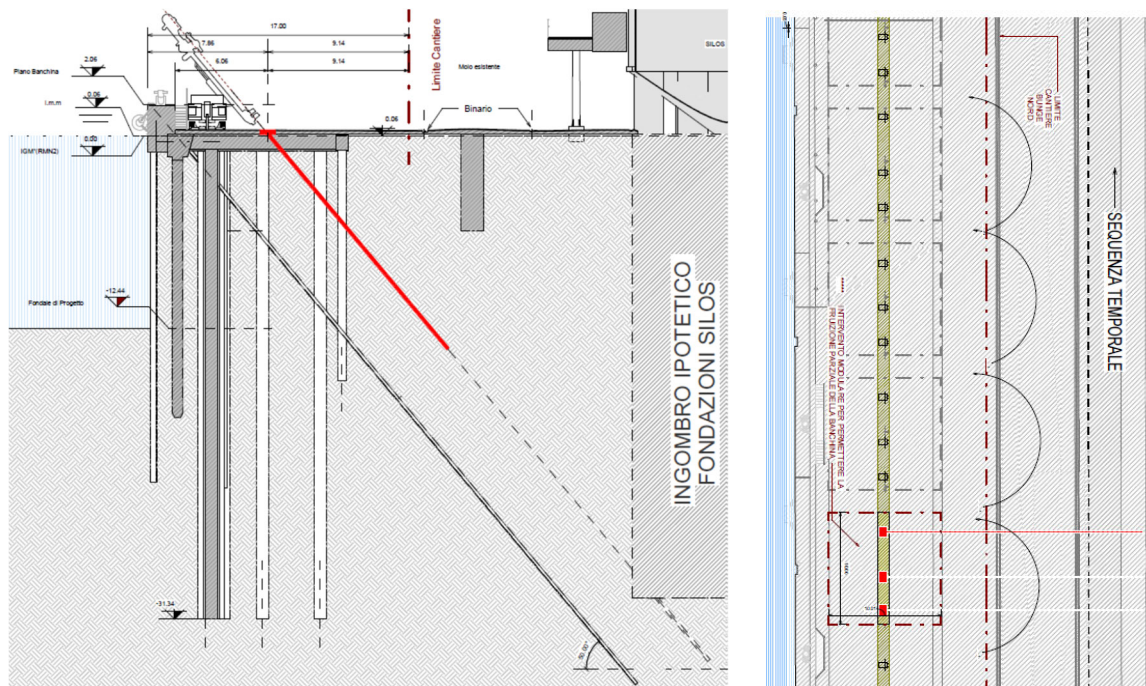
Banchina Bunge Nord – Fase 2 – Sezione e planimetria
